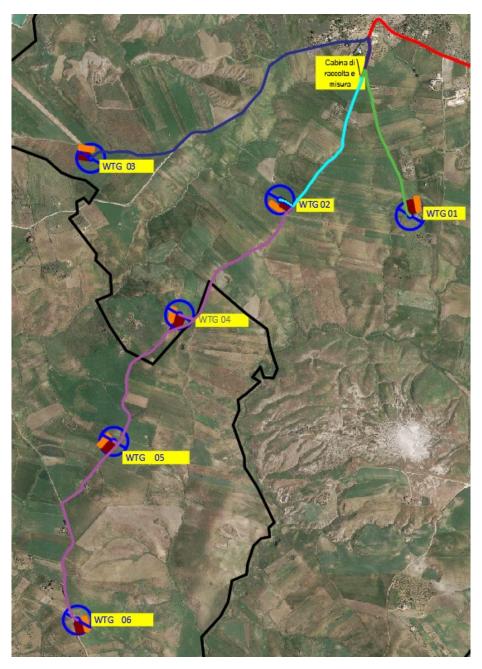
Tratte elettriche dell'Impianto Eolico su Ortofoto
